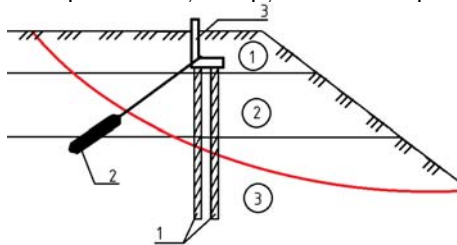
Схема усиления оползневого склона с помощью свай ЭРТ (РИТ, ЭРСТ, ФОРСТ) и грунтобетона: 1 – сваи ЭРТ; 2 – грунтобетонный анкер; 3 – уголкообразная монолитная ж/б подпорная стена; (1)–(3) – инженерно-геологические элементы
